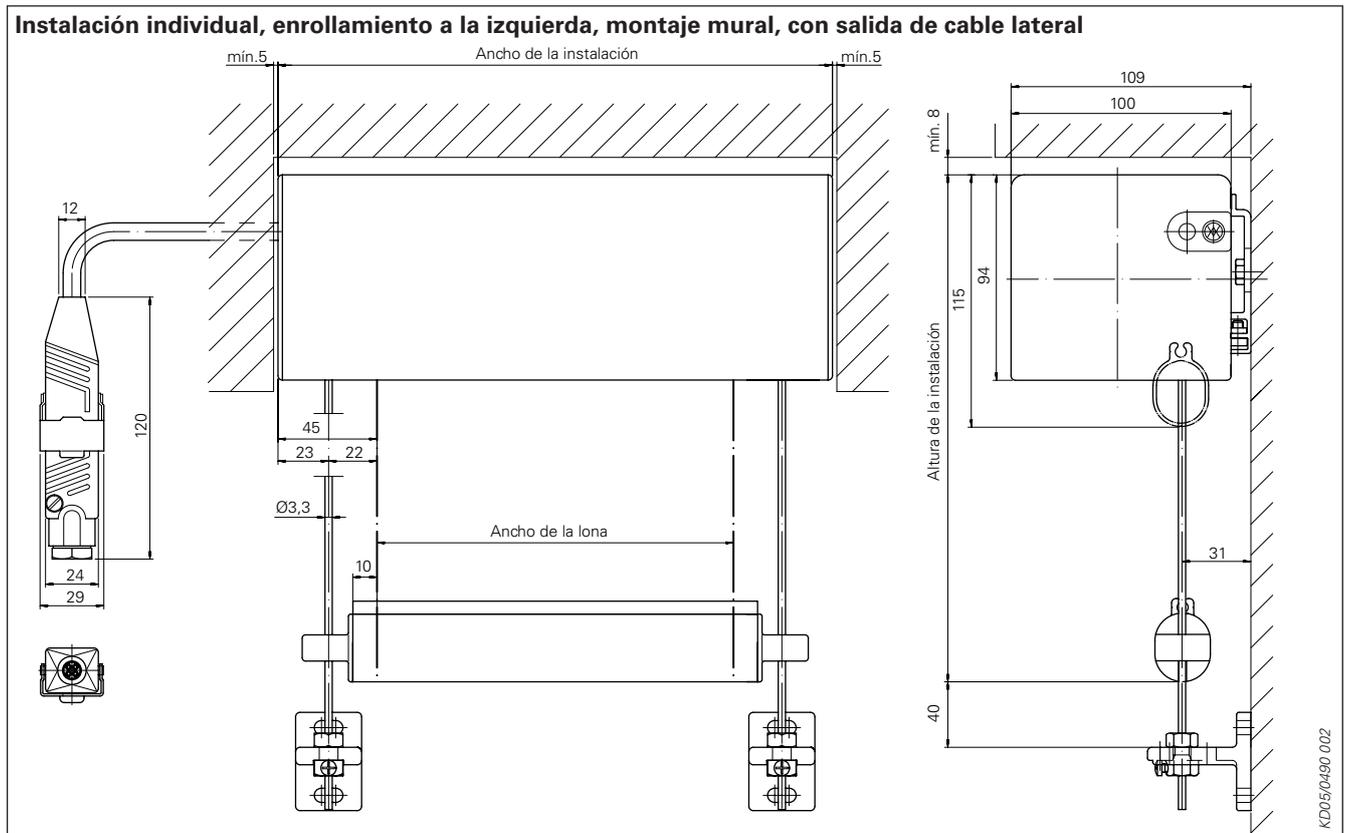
Instalación individual, enrollamiento a la izquierda, montaje mural, con salida de cable lateral
